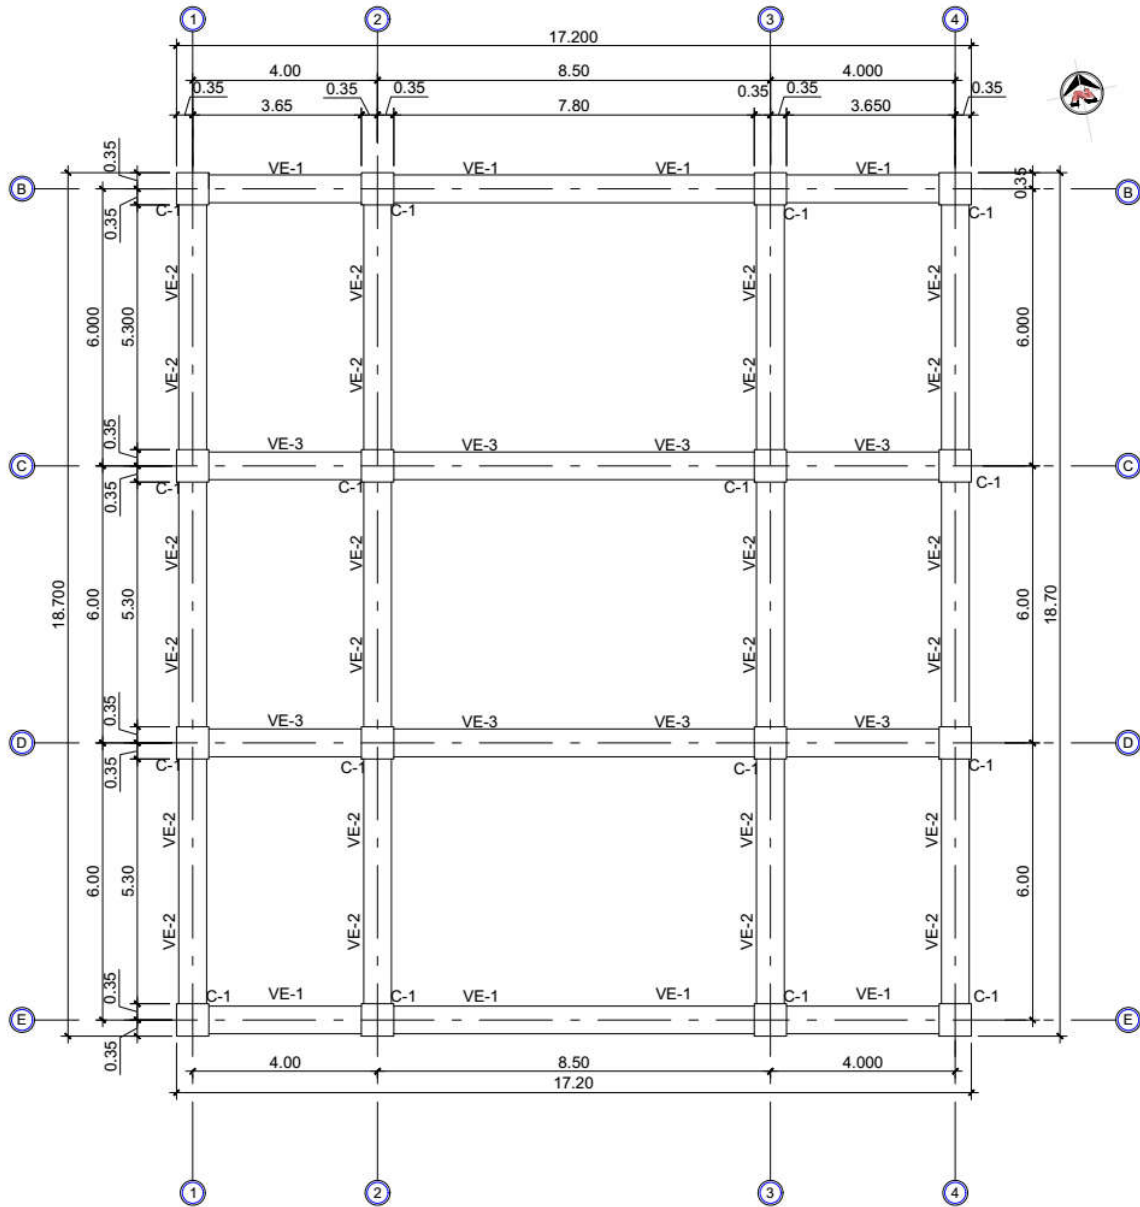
Planta típica del edificio (dimensiones en metros)
